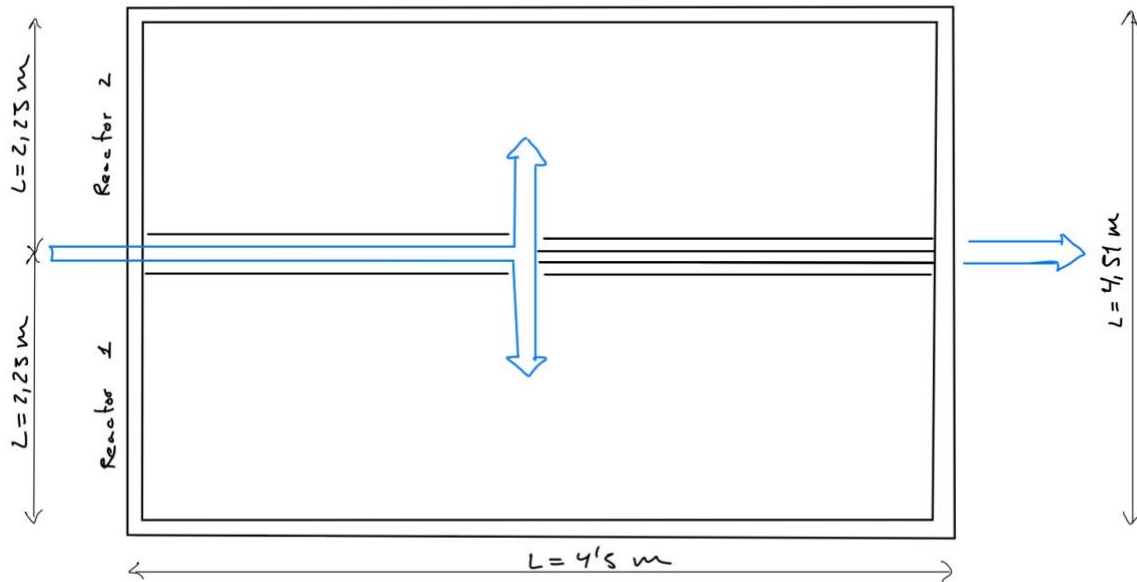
Plano en planta del conjunto de reactores (Boceto). Fuente: Elaboración propia
